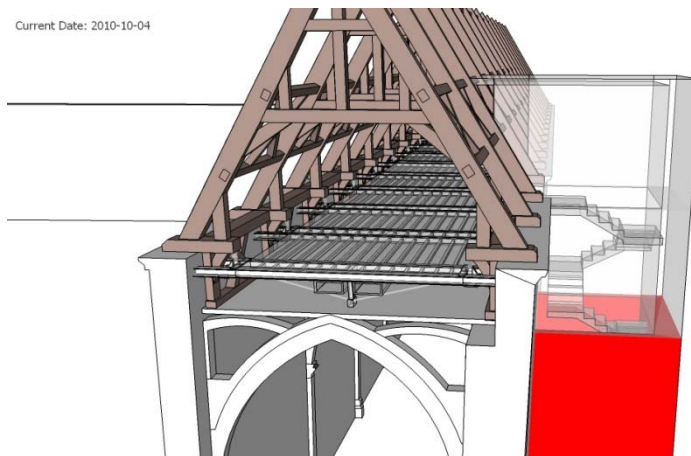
Début de la construction de la tourelle en béton et achèvement de la pose de la première poutre IPE.
